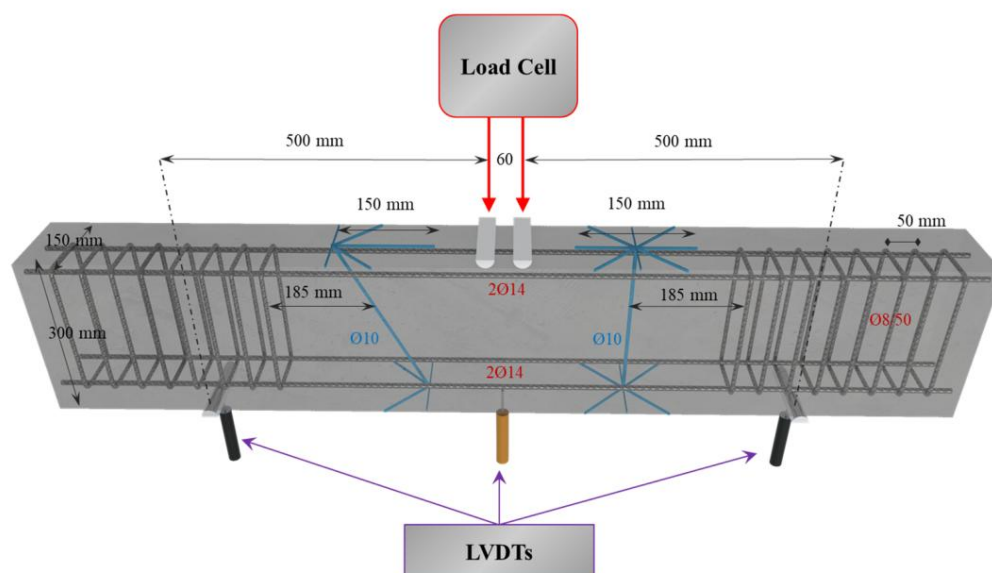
Geometrie- und Bewehrungsdetails des Trägers R-Deep Beam.
